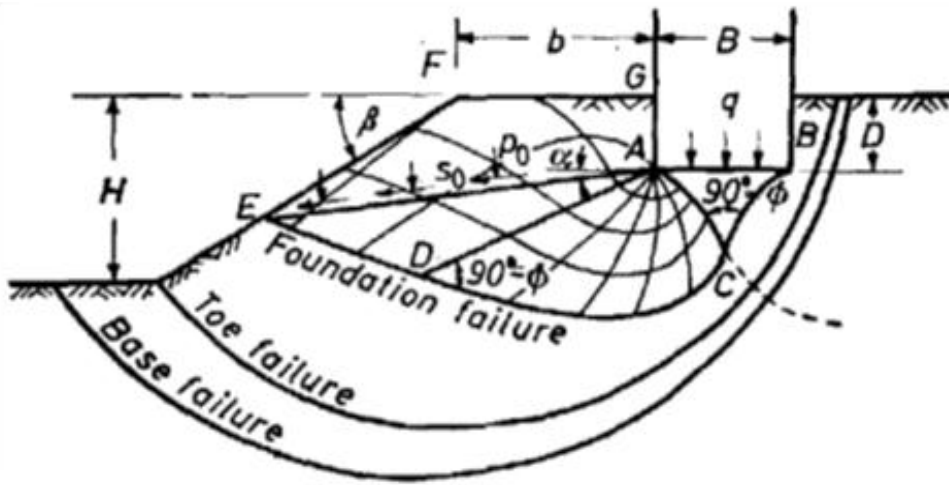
Surface de rupture d'une Fondation filante au bord d'une pente d'après Meyerhof (1957)
